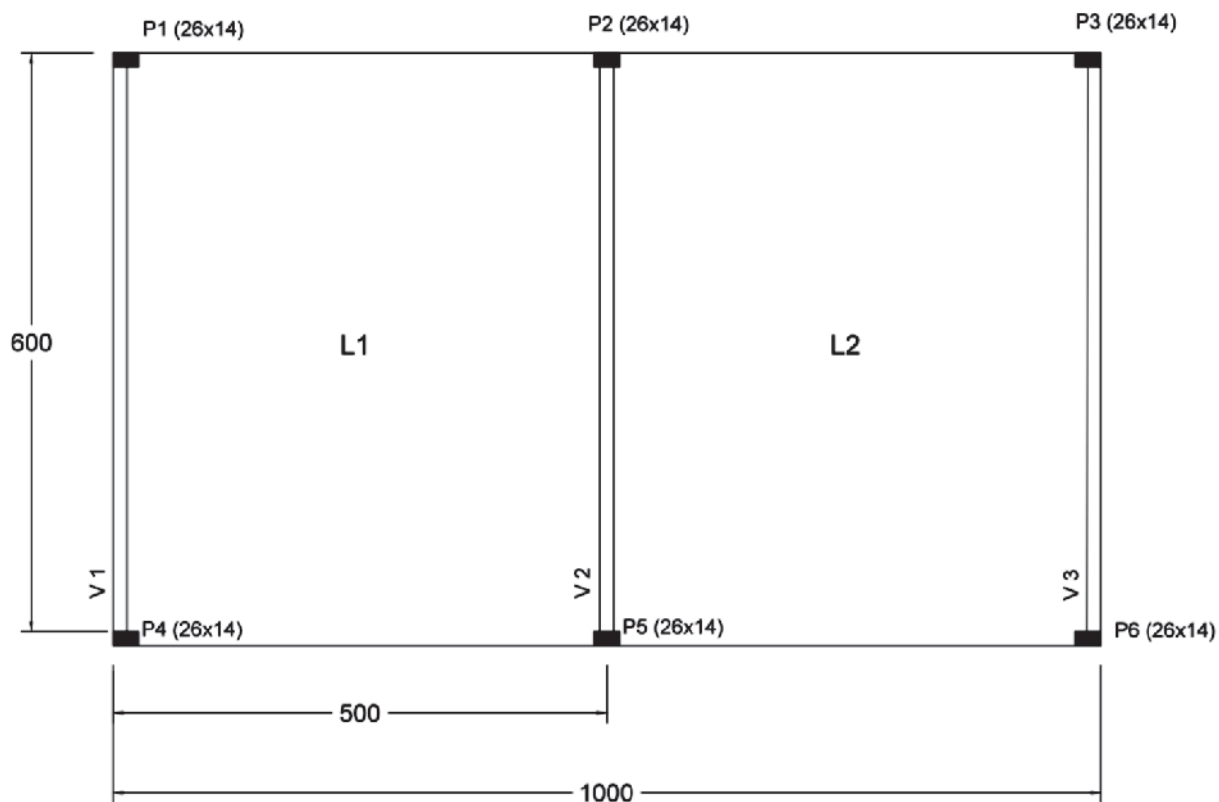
Pavimento considerado na análise: dimensões em centímetros
